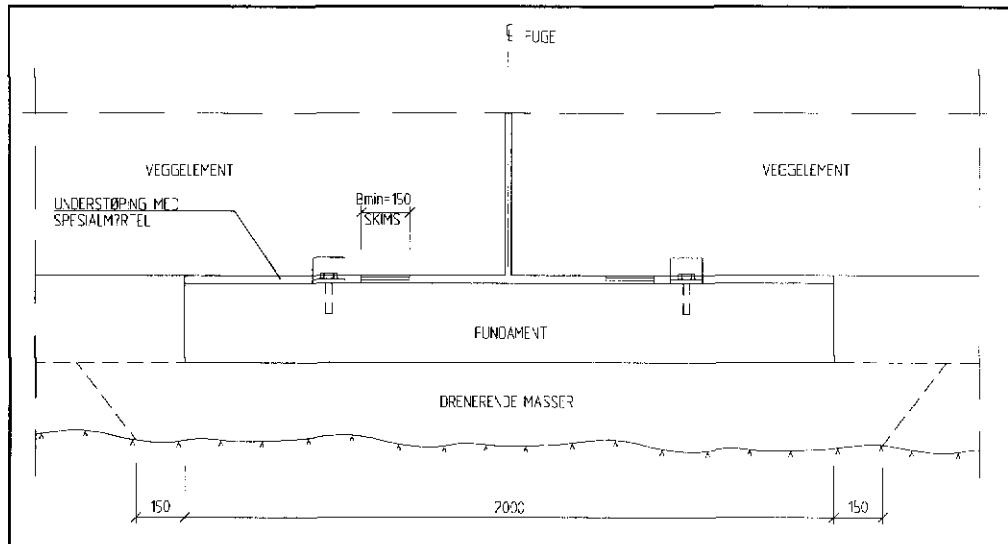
Tverrsnitt av isolert fundament for betongelementer.
